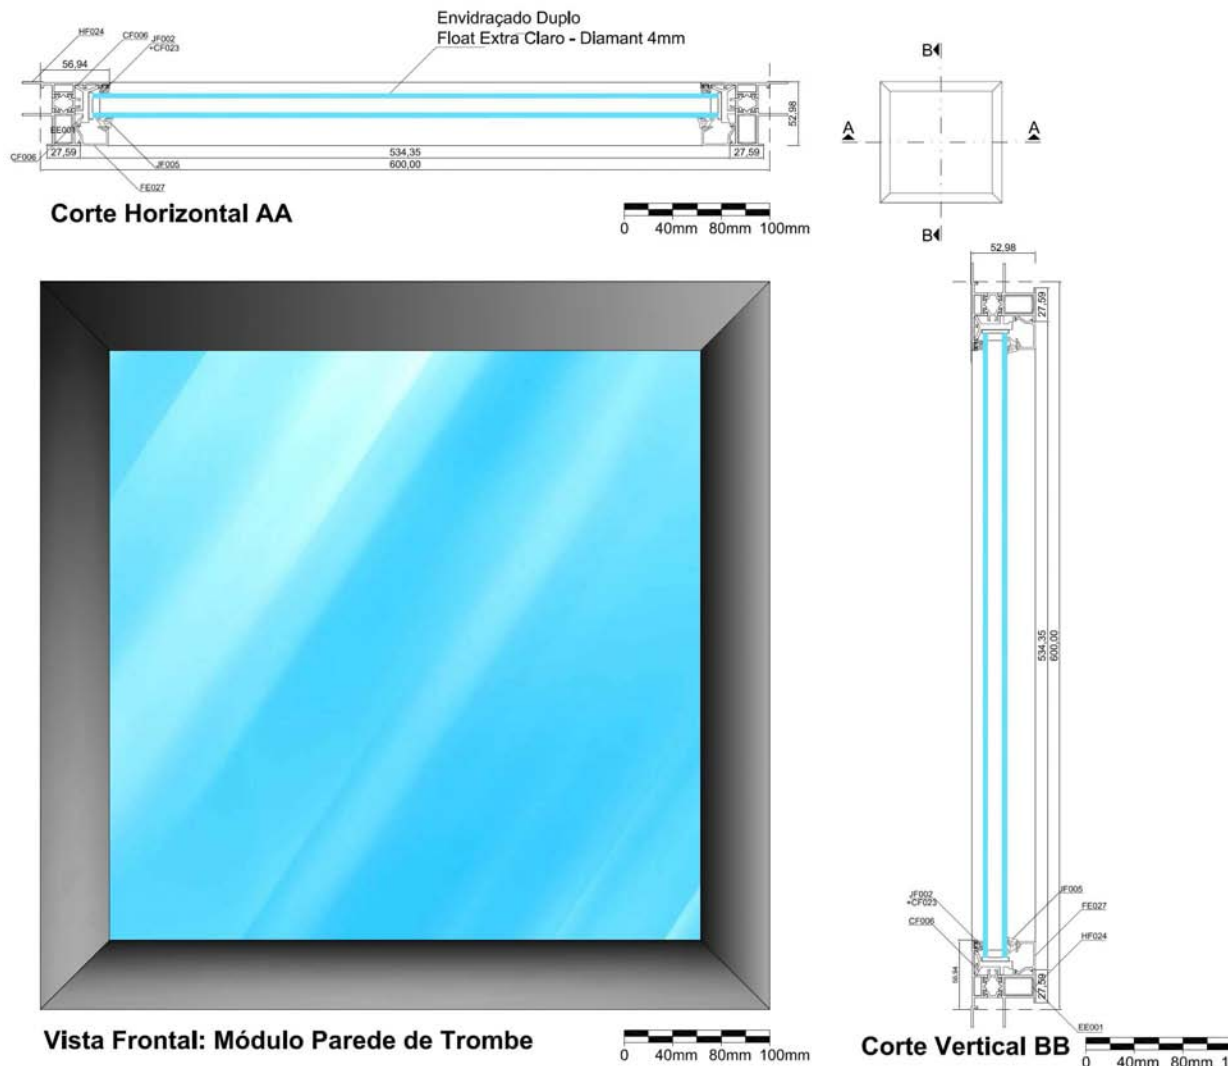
Cortes e vista do módulo parede de Trombe, também composto por perfis FXi como o módulo padrão fixo.
